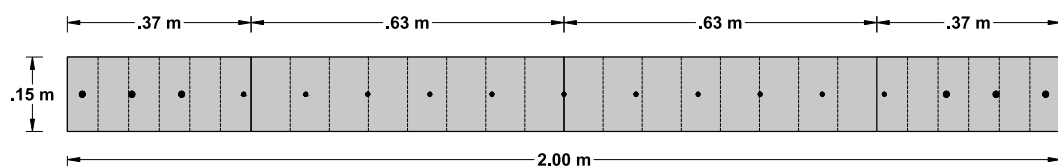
Detallado y refuerzo del espécimen WHS6. (Dazio et al.,2009).
